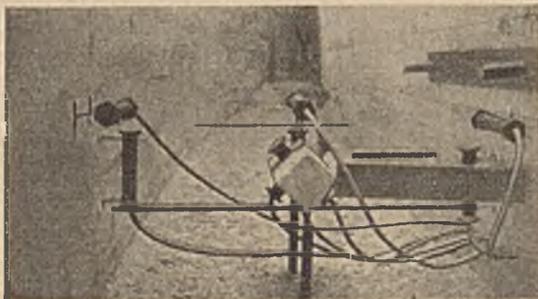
Telemetereinbau in die Stevenson Creek-Staumauer.
